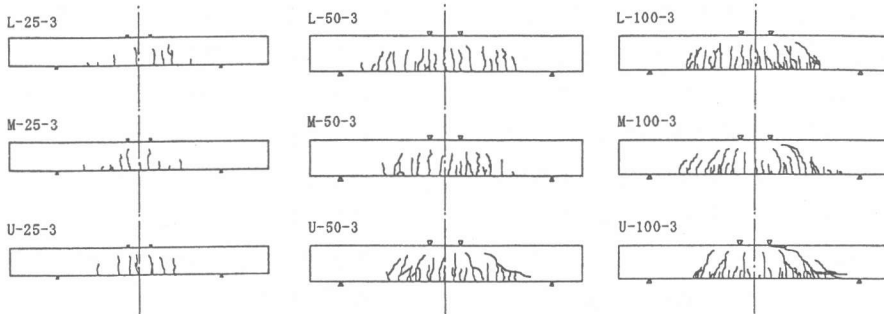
U-100-3の破壊時と同等のせん断強度となる破壊時のひび割れ進展図
